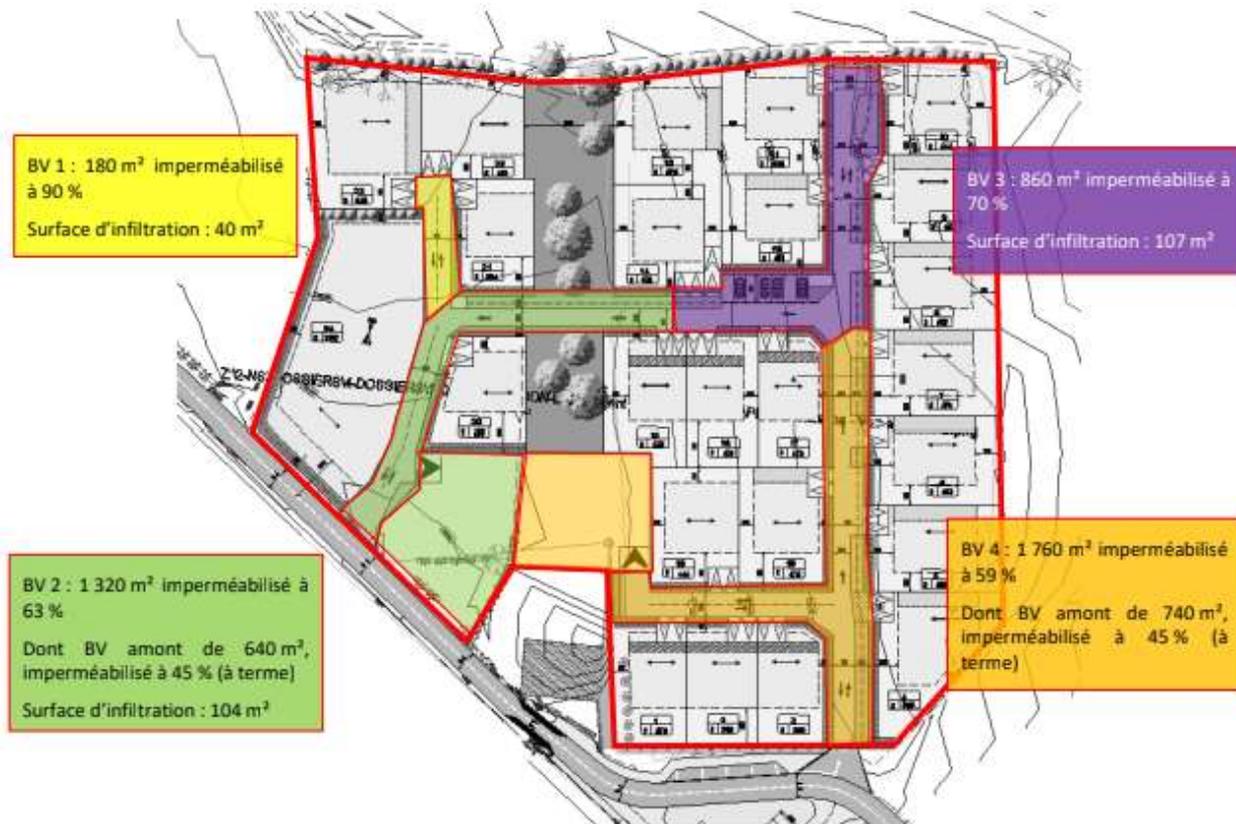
Détail du dimensionnement des noues d'infiltration sur les espaces publics - Plan de composition Nord Sud annoté 100 Senn
